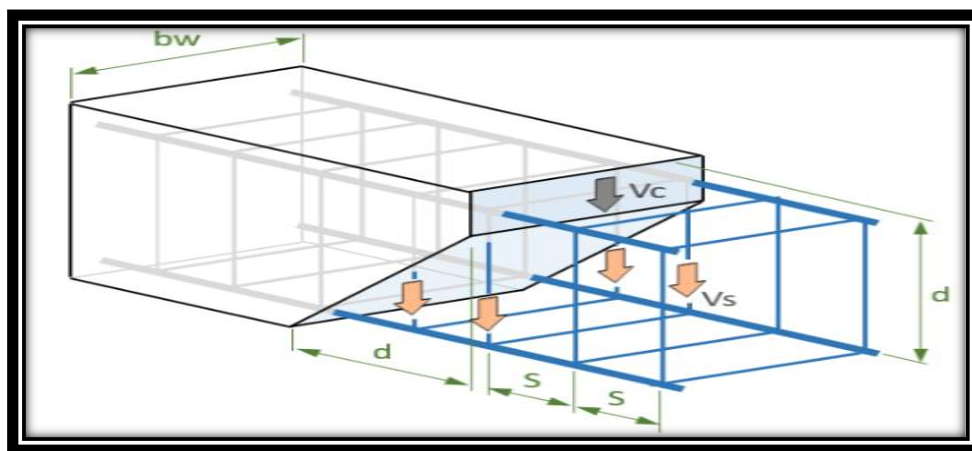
Poutre rectangulaire en béton avec armatures en acier est un exemple d'un élément en béton armé
